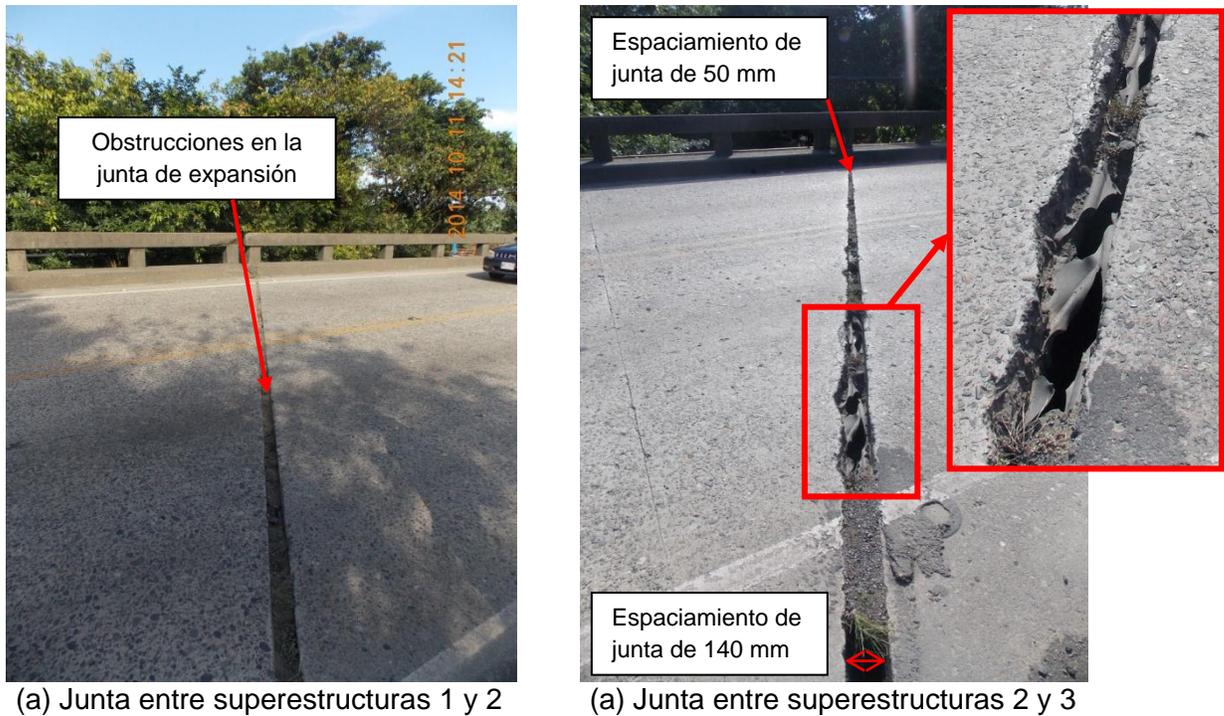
Daños en las juntas de expansión ubicadas sobre las pilas: desprendimiento de sello impermeable, obstrucciones y desprendimientos de concreto.
